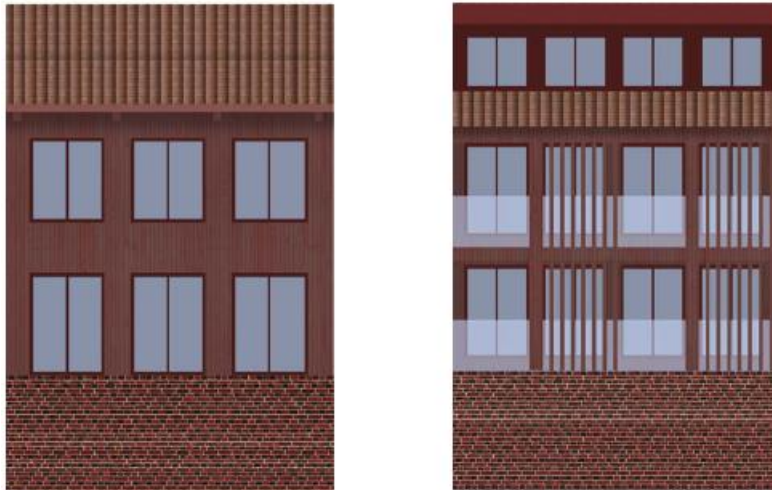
Föreslagen fasadindelning på punkthuset (Kontrollbolaget 2025).
